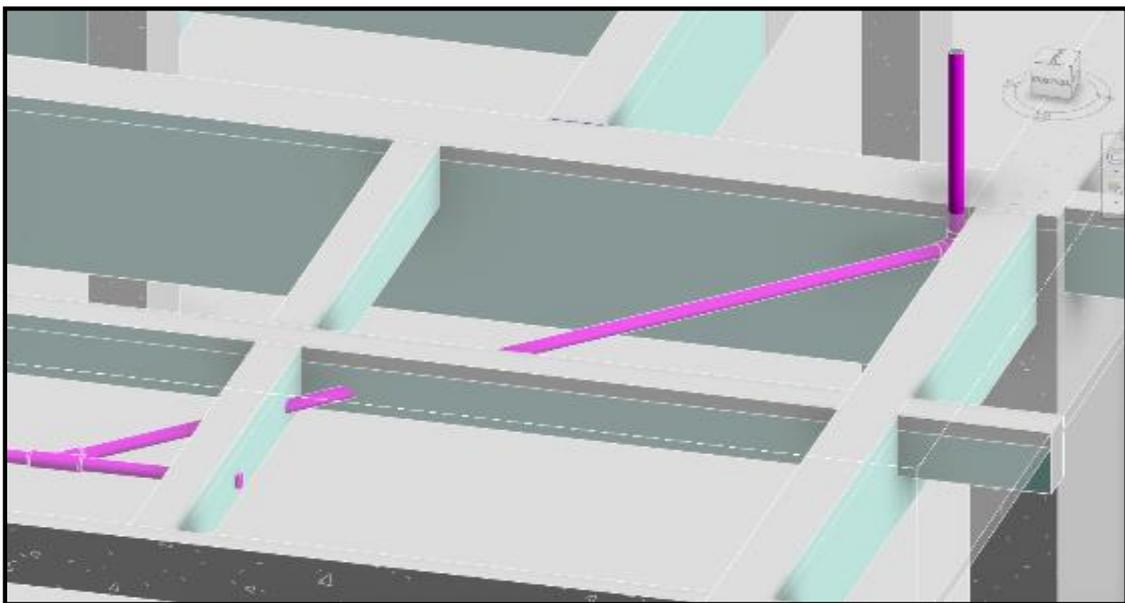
Tubería de desagüe de 4" cruza las 2 vigas estructurales
